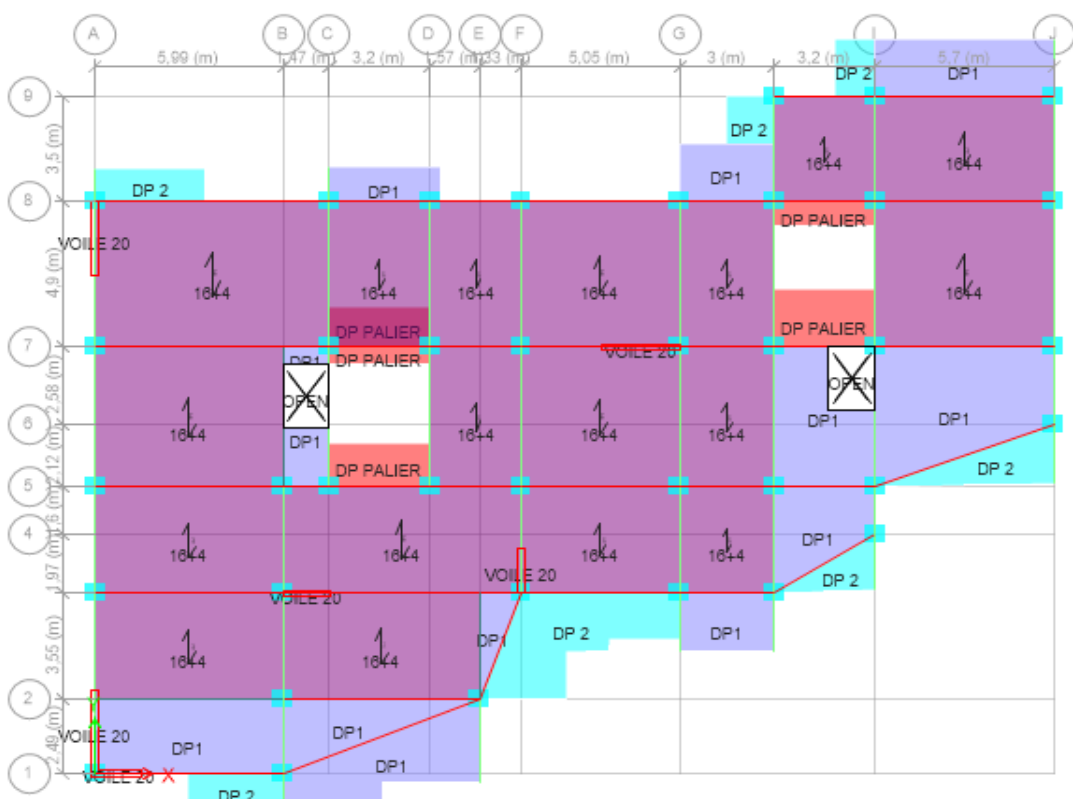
Schéma de la disposition des poutrelles pour l'étage courant
